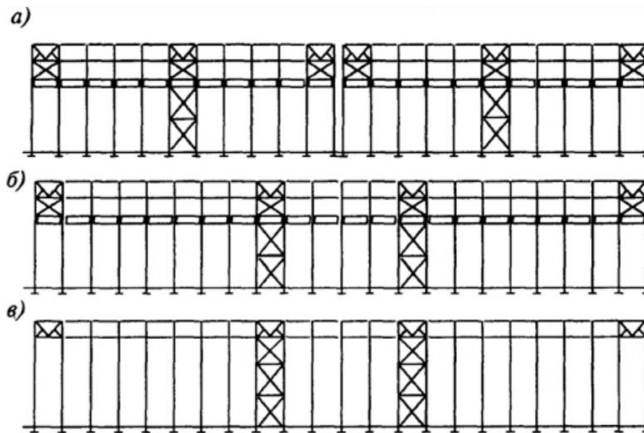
Схема связей по колоннам: а - в оборудованных мостовыми кранами зданиях с 2-мя температурными блоками; б - в оборудованных мостовыми кранами зданиях с 1-м температурным блоком; в - в бескрановых зданиях
